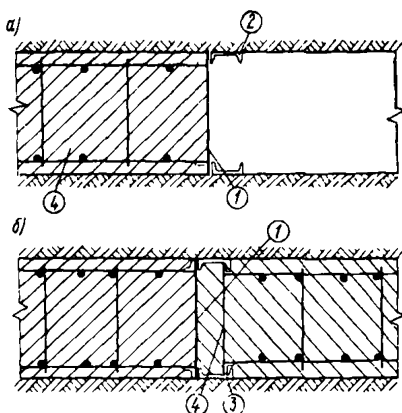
(3). Рабочий стык бетонирования монолитной стены
